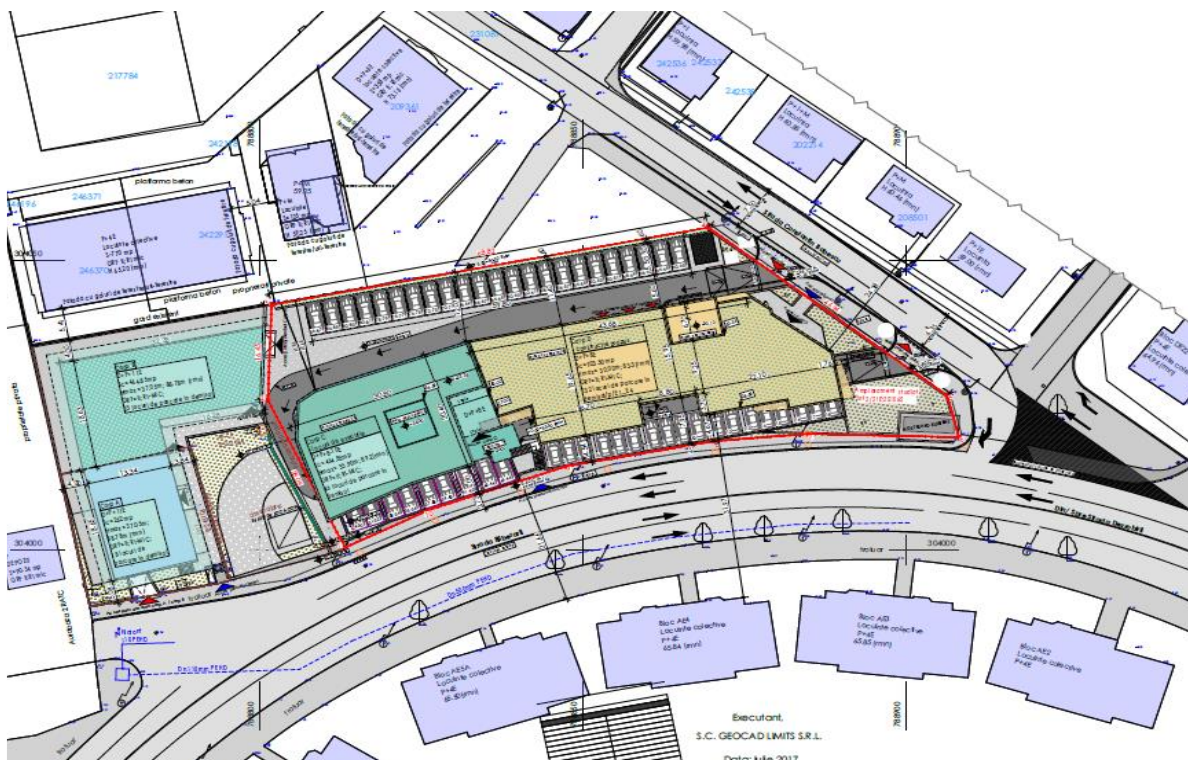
Plan de situație (corp D-identificat prin culoarea galbena pe plan)
